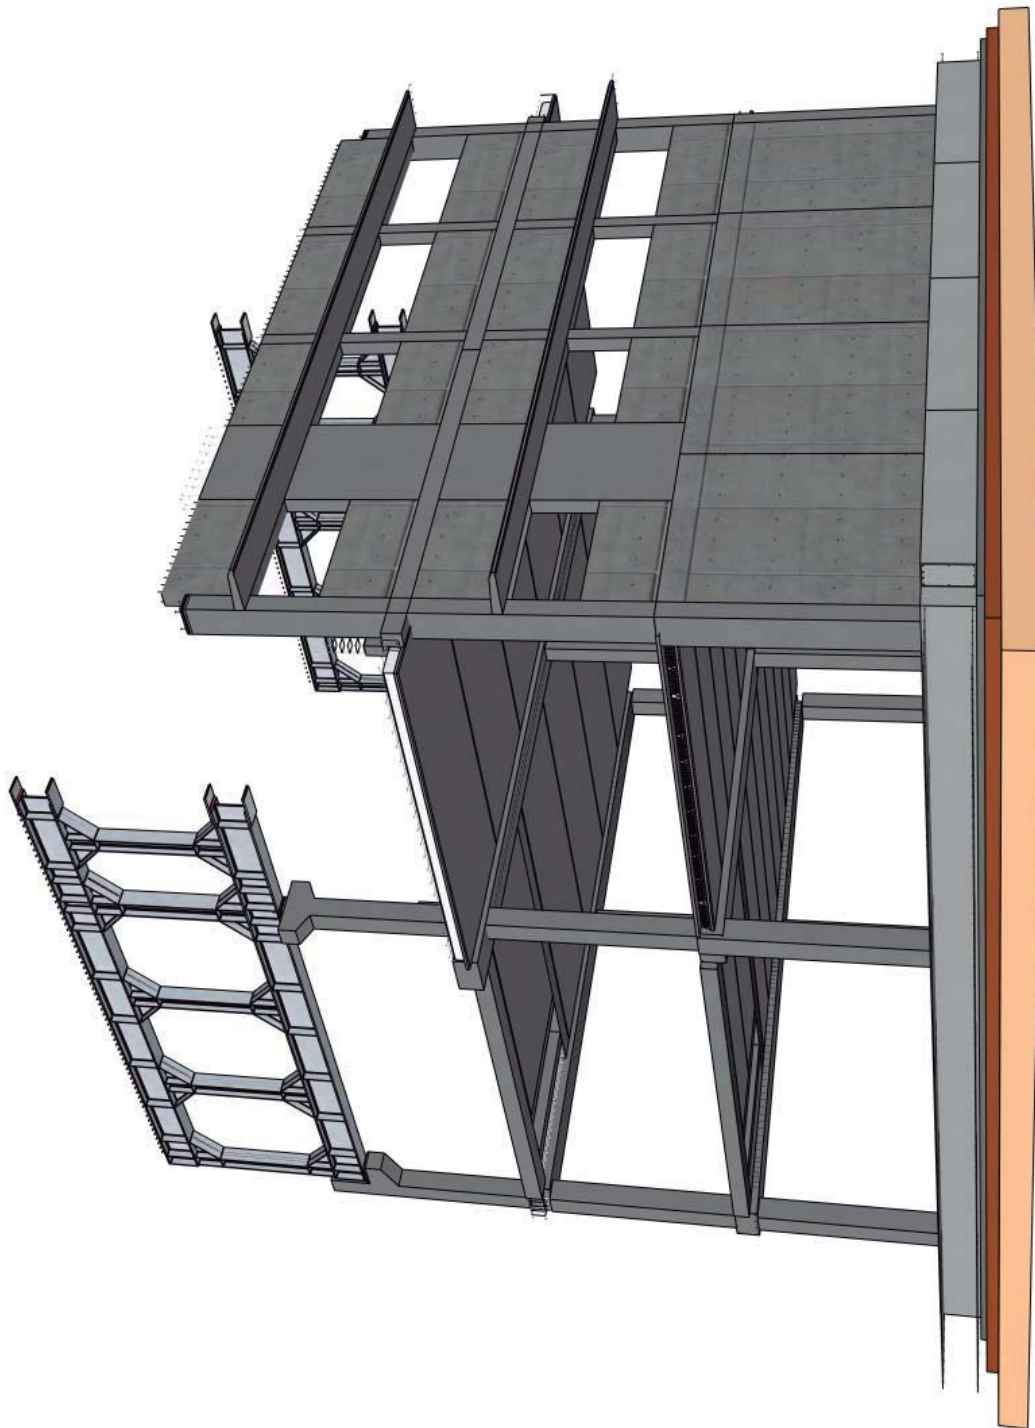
Colocación de los dos tramos interiores de la estructura metálica del voladizo.
